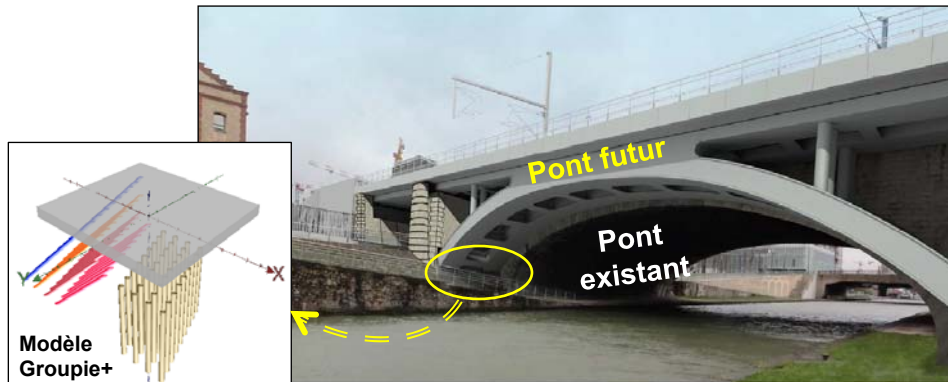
Elargissement d'un pont rail existant – modélisation du massif de fondation
